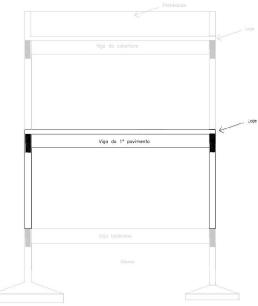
Esquema genérico destacando os elementos contemplados no mapa iluminado do 1º pavimento.
